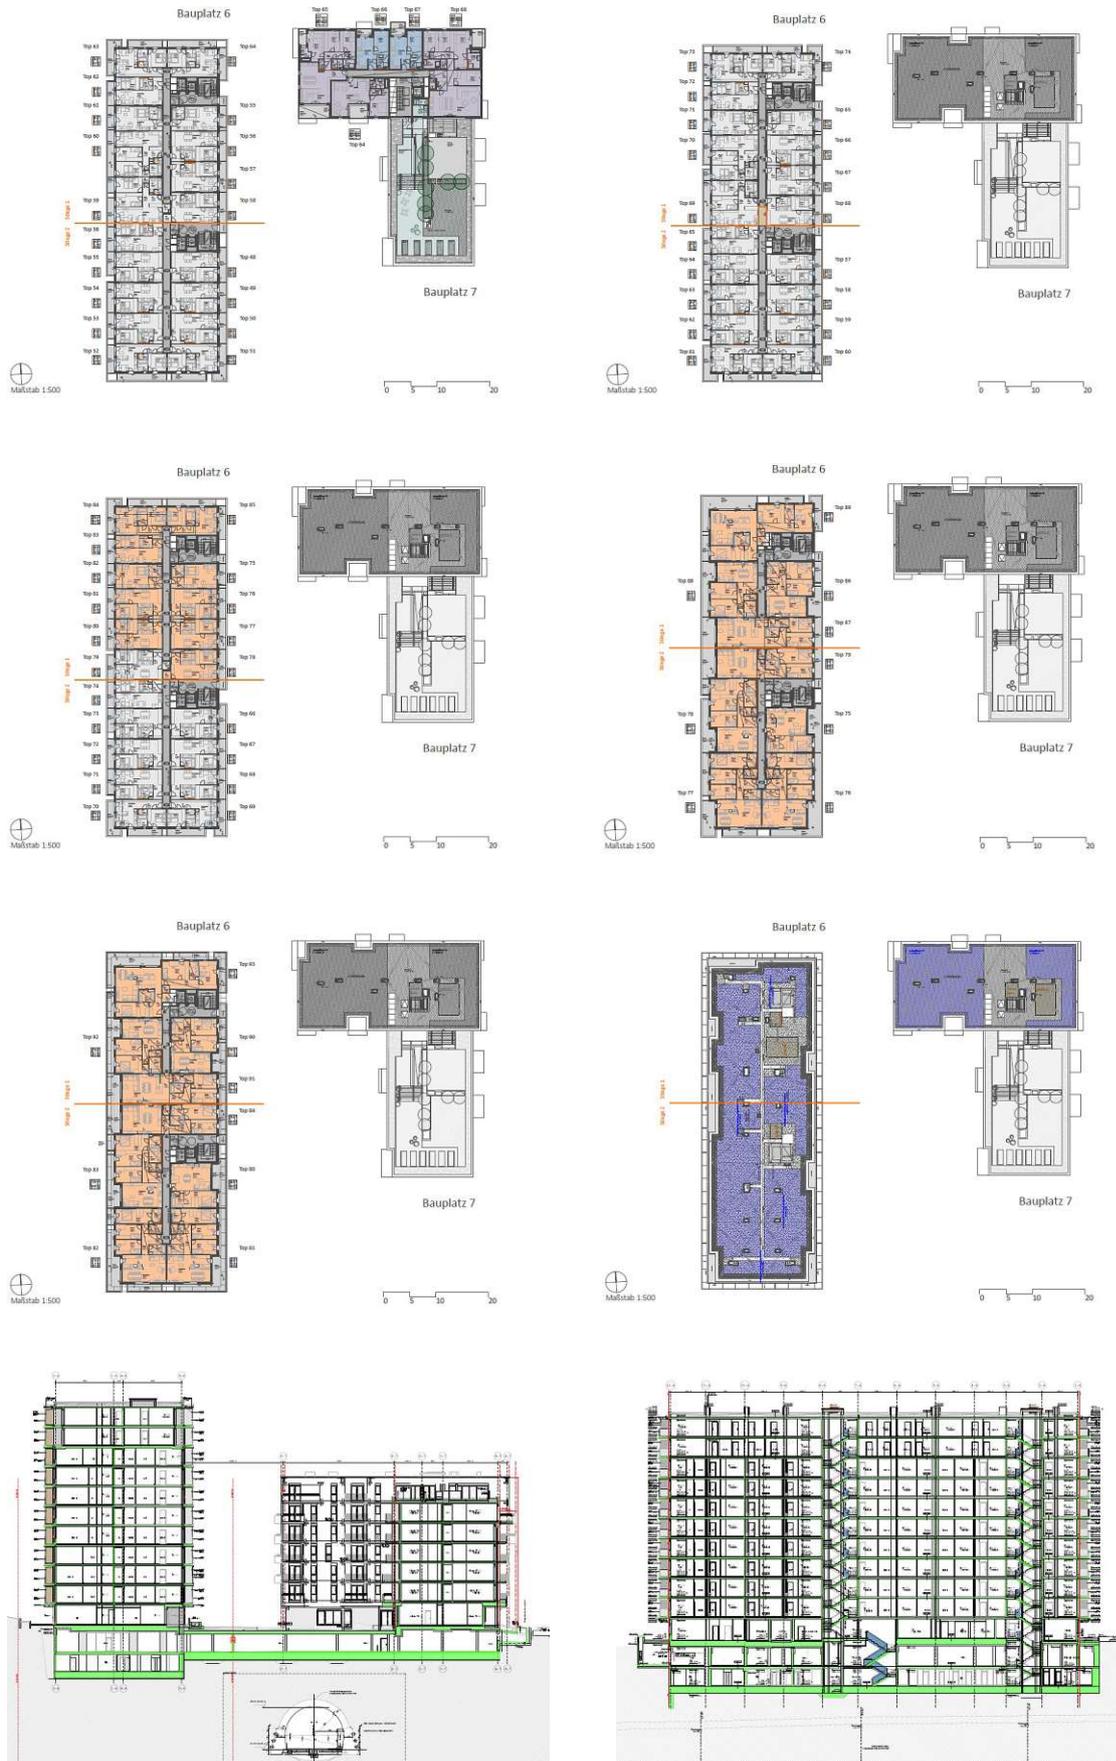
161: THEOs Bpl.6-7 Grundrisse UG – OG und Schnitte, S. 405
